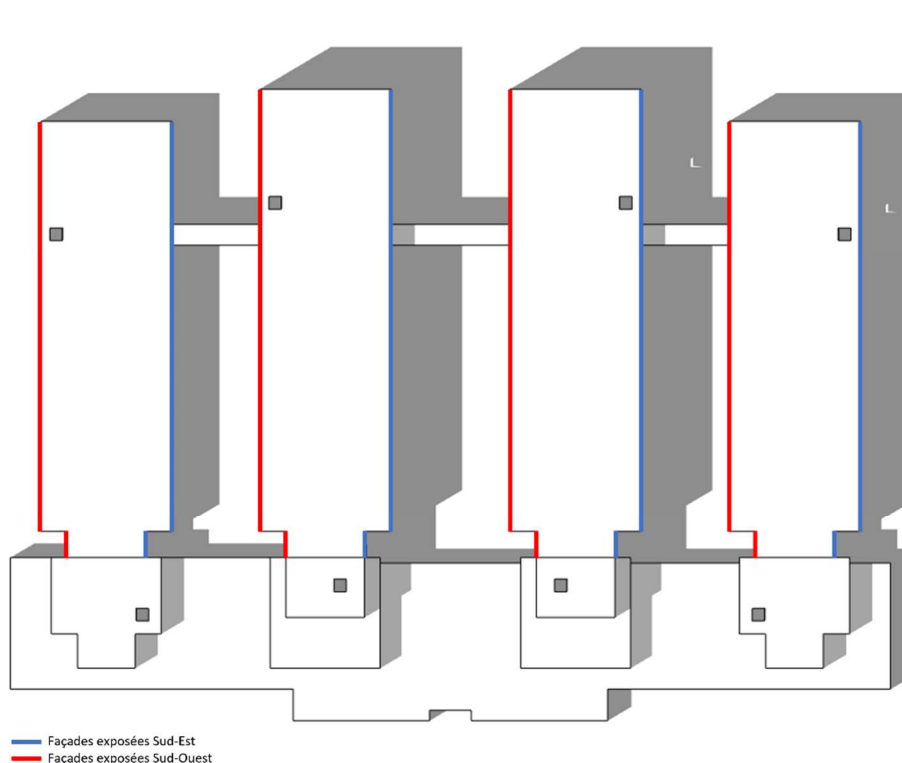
Vue en plan : Façades Sud-Est et Sud-Ouest en exposition directe aux rayons solaires
